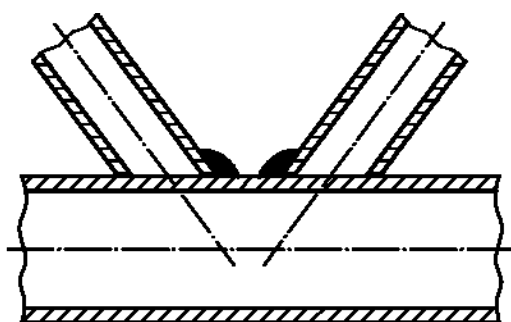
Підготовка та підгонка зварного шва для кутових з'єднань порожнистого профілю
